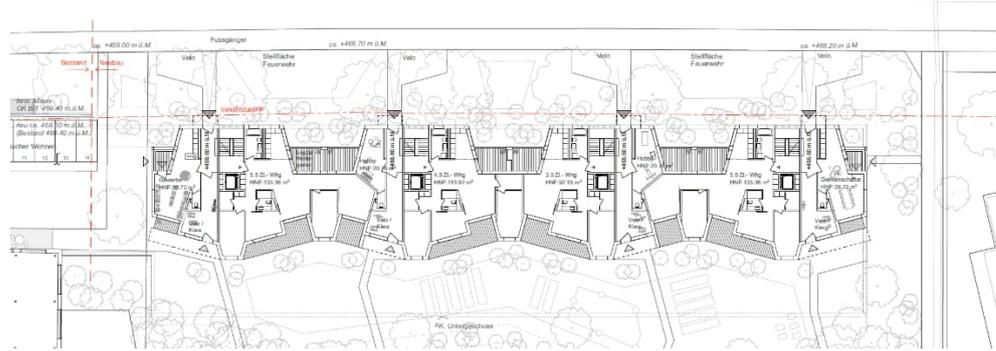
Grundriss Erdgeschoss (Bob Gysin Architekten 2024)
